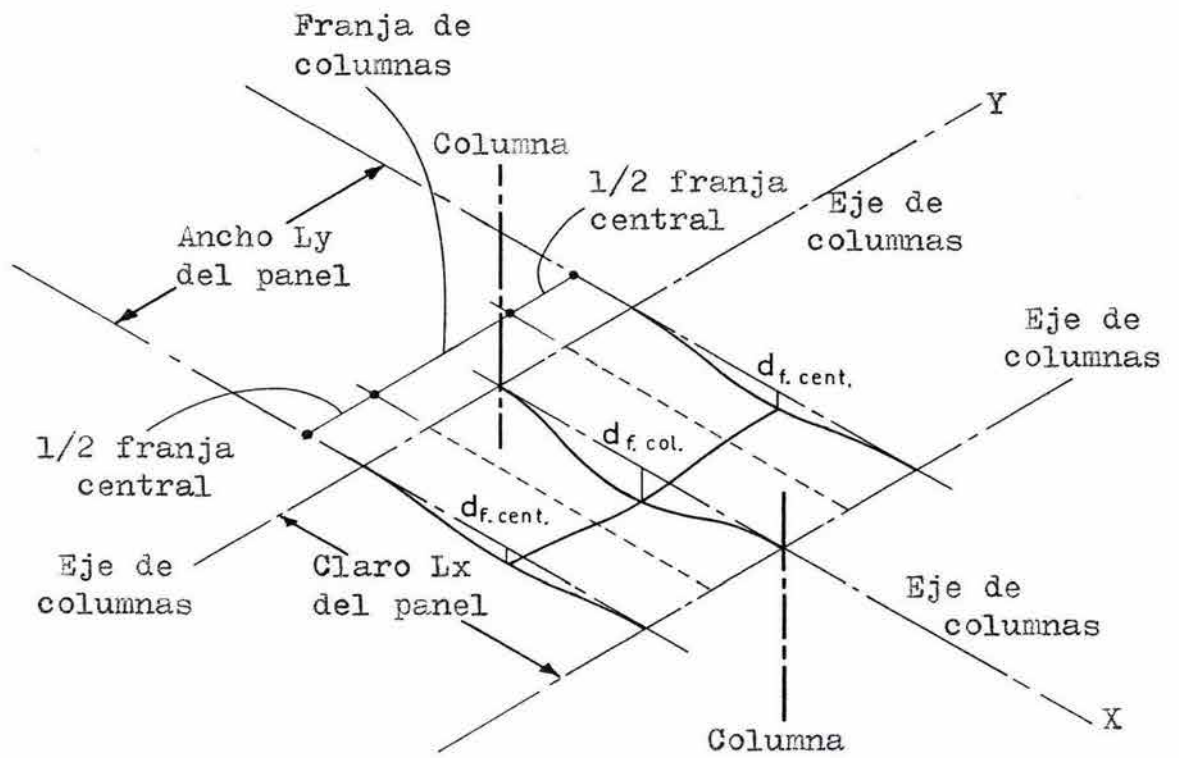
DEFLEXION DE LAS FRANJAS DE COLUMNAS Y CENTRAL EN LA DIRECCION X.
